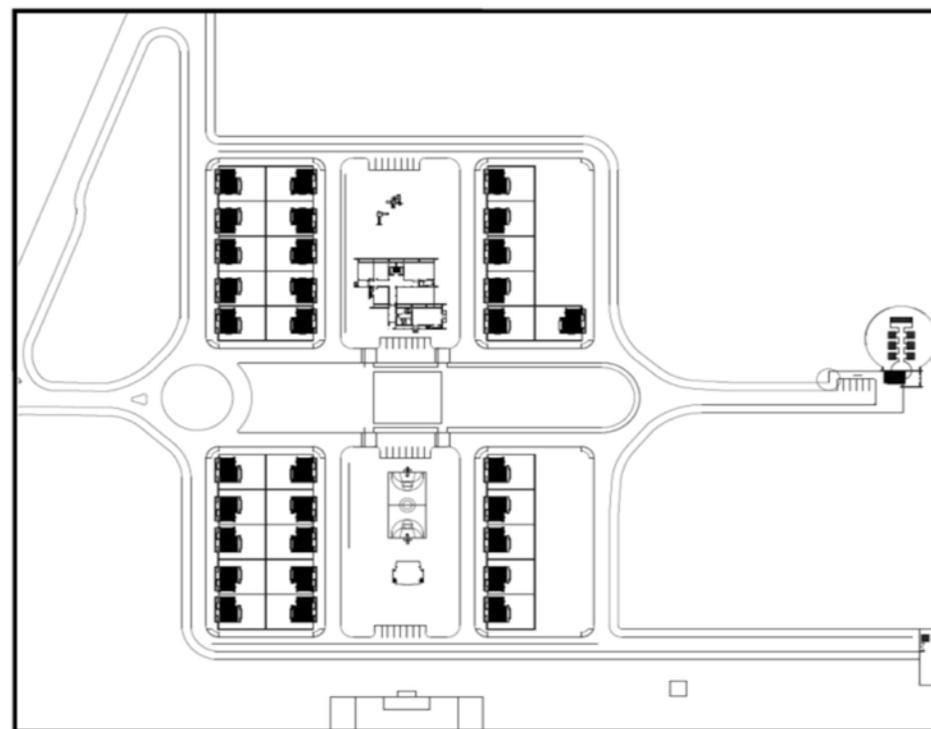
Plano arquitectónico 1. Plano de "Nuevas Casitas" suministrado por la empresa a la comunidad.
